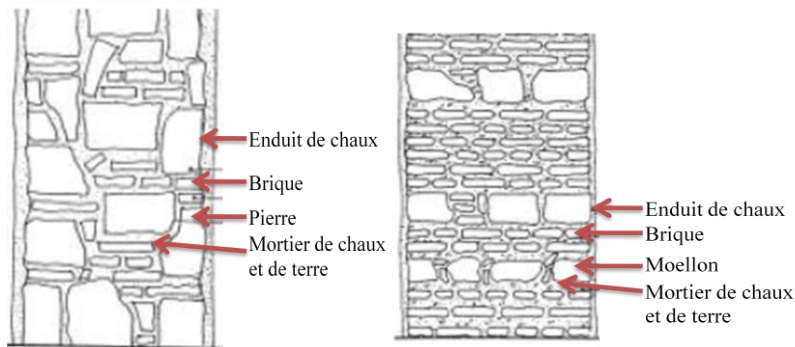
Principe constructif d'un mur en pierre brute hourdée.
